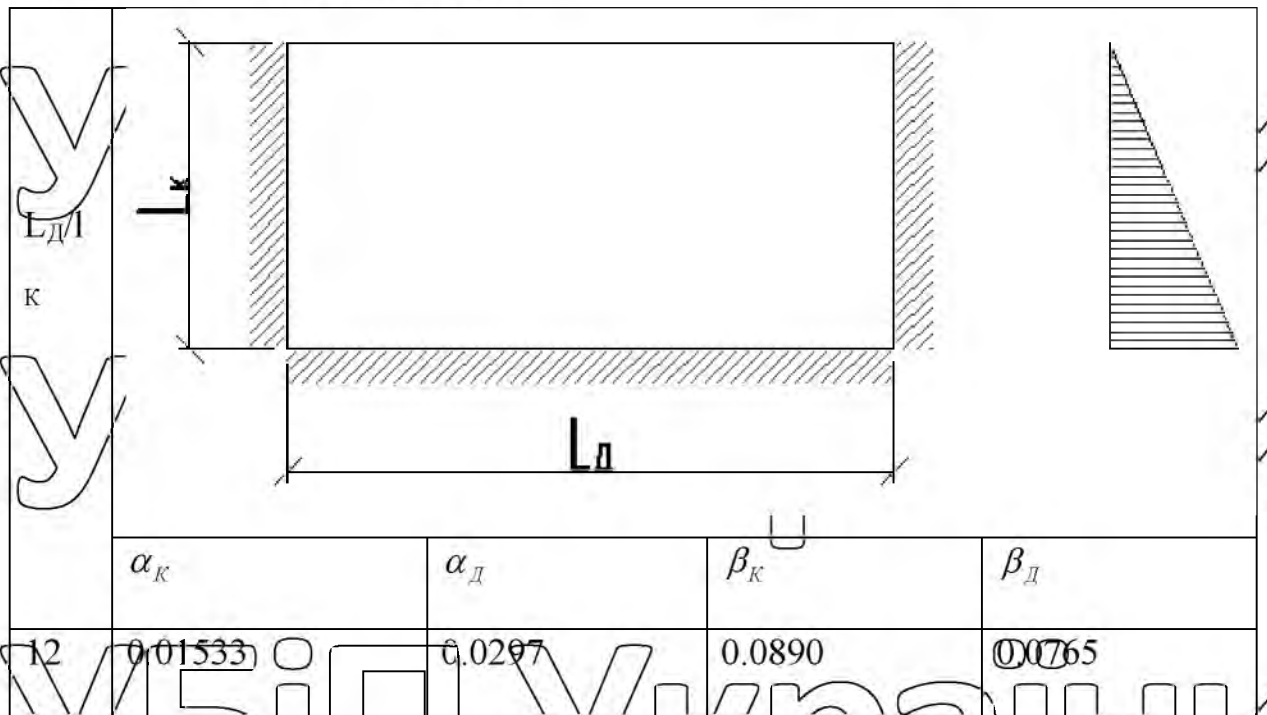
Розрахункова схема чаші басейну
